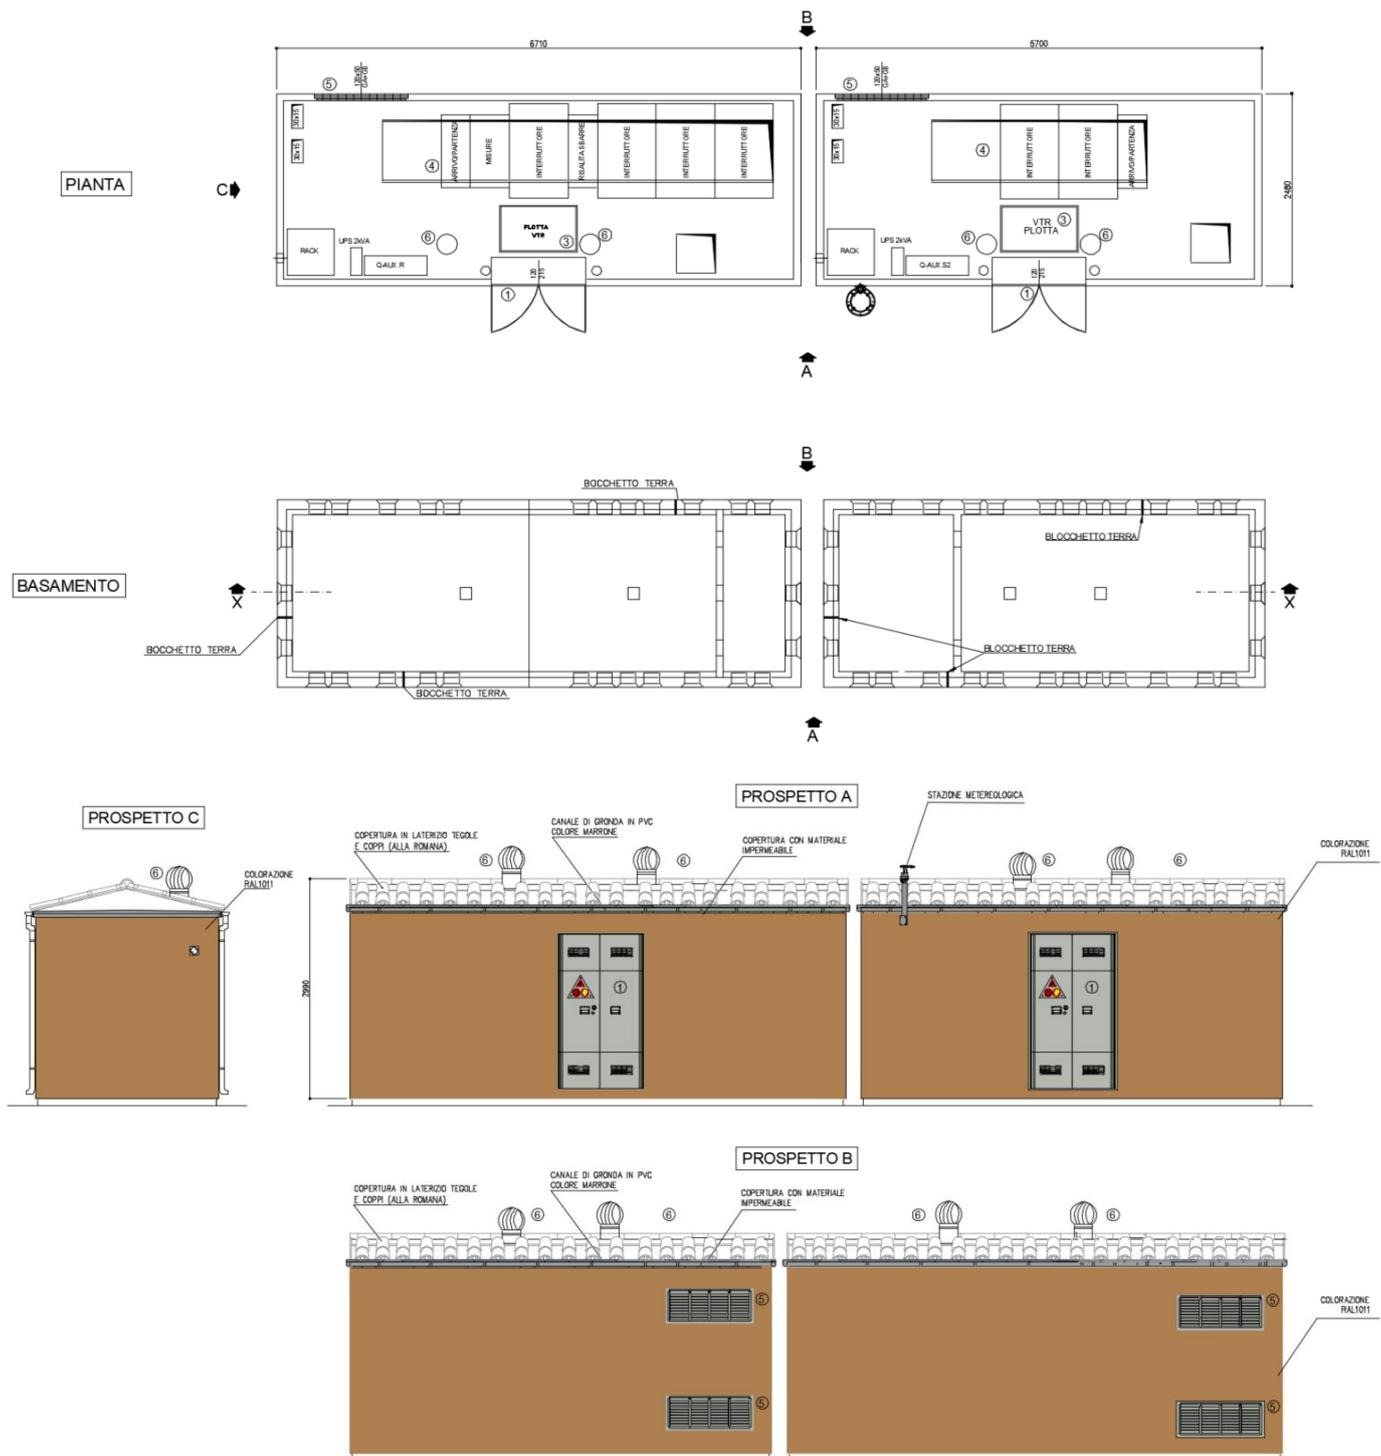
Pianta e prospetti cabina di ricezione lotto 2
